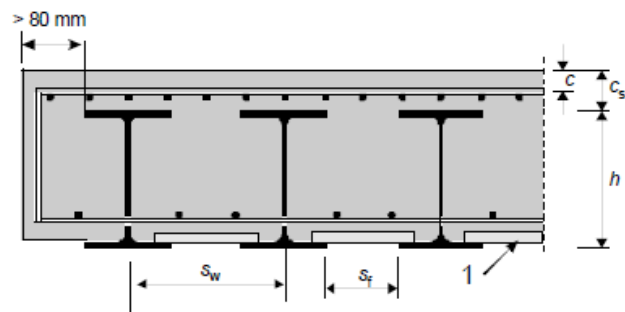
Classificatie van gemengde staal-betonconstructies
